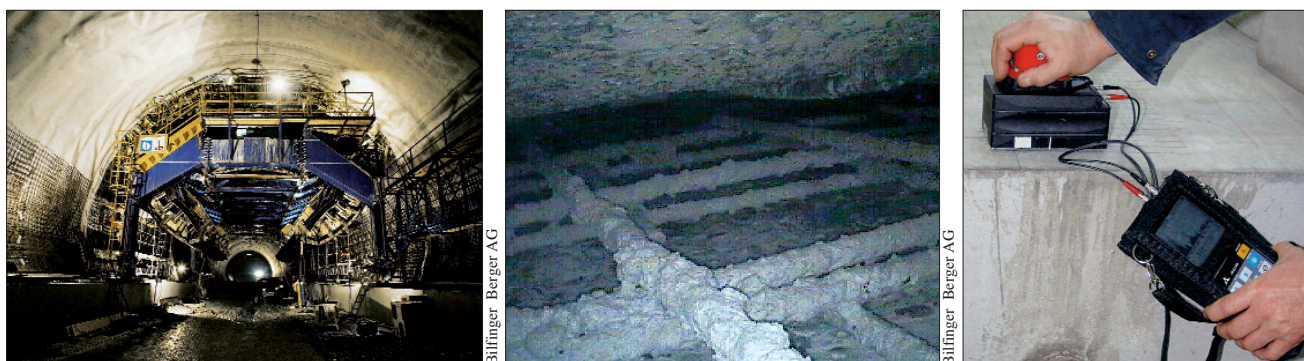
(a): Tunnelinnenschale; (b): detektierte Fehlstelle mit freiliegender Bewehrung in einer Tunnelinnenschale, (c): Handgerät zur Ultraschallecho-Prüfung
